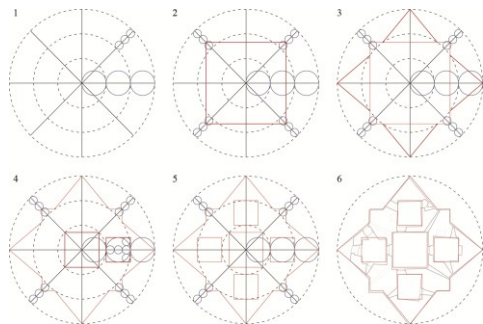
Costruzione geometrica attraverso i moduli costruttivi di base e sovrapposizione della costruzione geometrica con la planimetria
